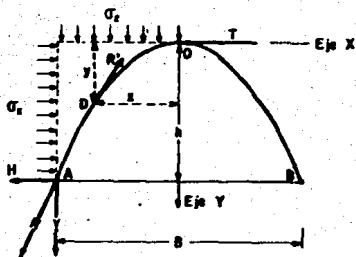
Croquis explicativo para plantear el método de Pröschky-Schöner (Ref. 3).
